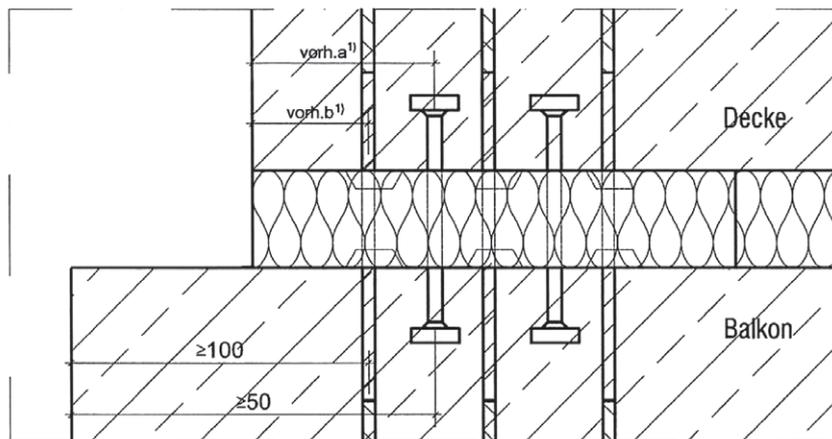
Rand- und Dehnfugenabstände [mm] der Querkräftstäbe und Stahldrucklager (Schöck Isokorb Typ QP)
